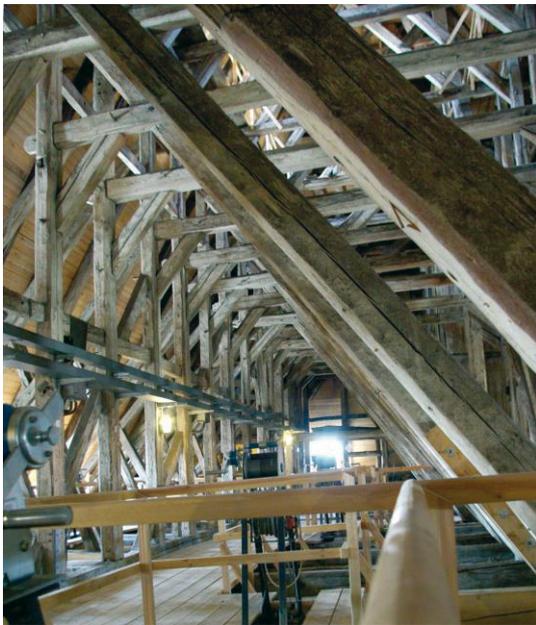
Ulrichskirche in Halle a.d. Saale, Dach über dem Hauptschiff: ein „verbauter Wald“.
